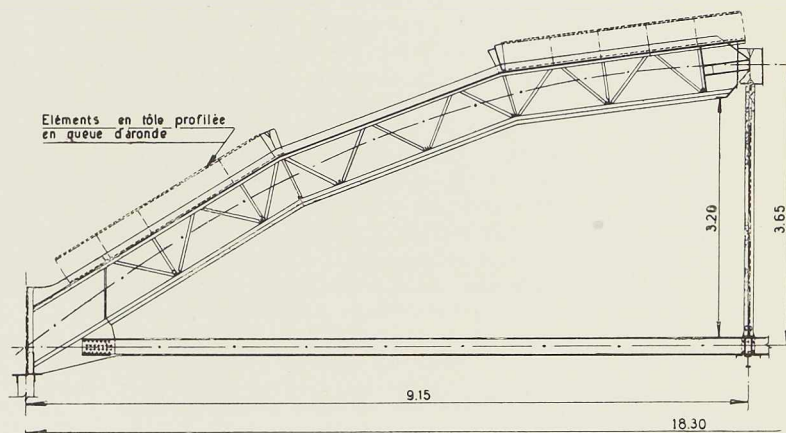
Coupe verticale dans une ferme de toiture réalisée pour l'usine de la Steel Ceilings Ltd. à Hayes (Angleterre).
